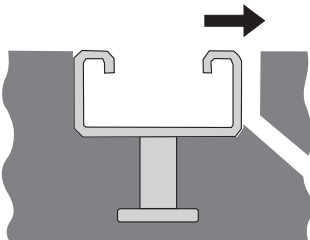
槽型预埋件的混凝土边缘承受剪力荷载
